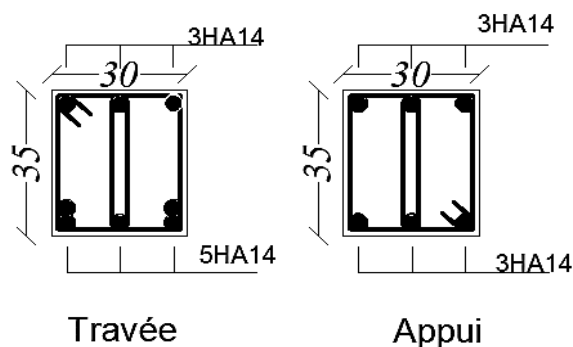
Schéma de ferrailage de poutre palière en béton léger.
